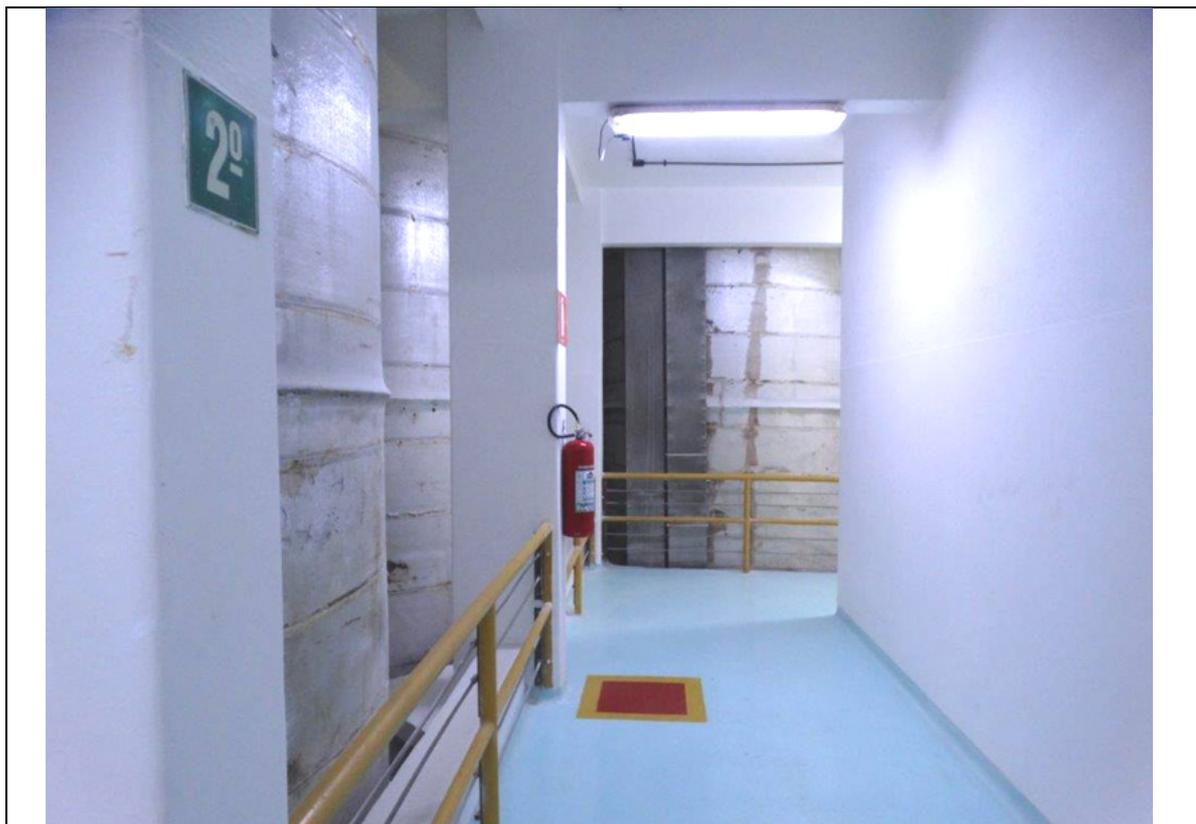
PRÉDIO H0 - 2º ANDAR.
